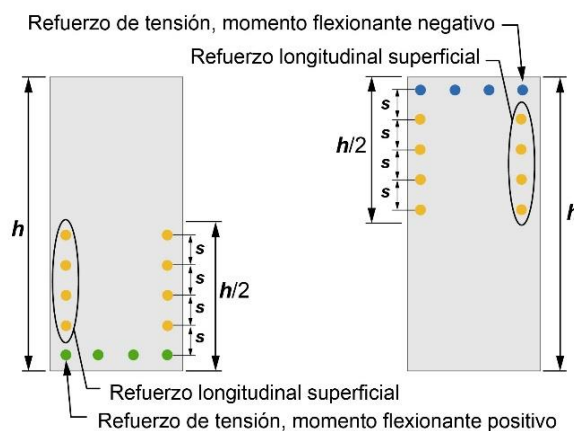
Refuerzo longitudinal superficial en vigas con $h > 900 \text{ mm}$ (adaptada de ACI CODE-318-19)
